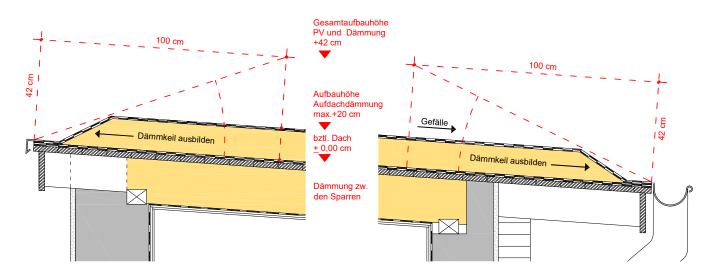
Schematische Darstellung Aufbauhöhen Dämmung Dach und Aufstellung Solaranlagen bei einem Einfamilienhaus der Waldsiedlung Zehlendorf.
